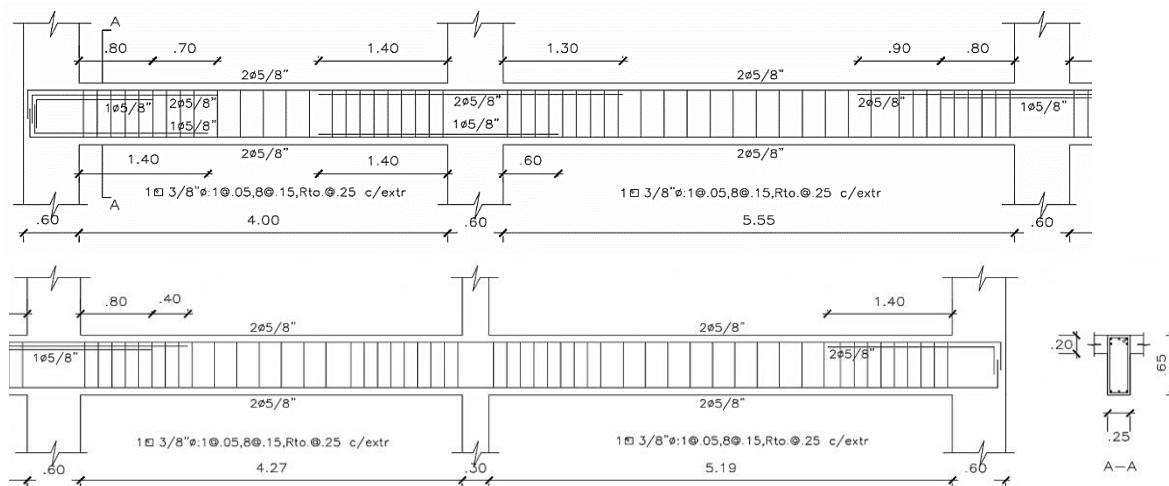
Detalle de armado de la viga VT-02 de sistema dual
